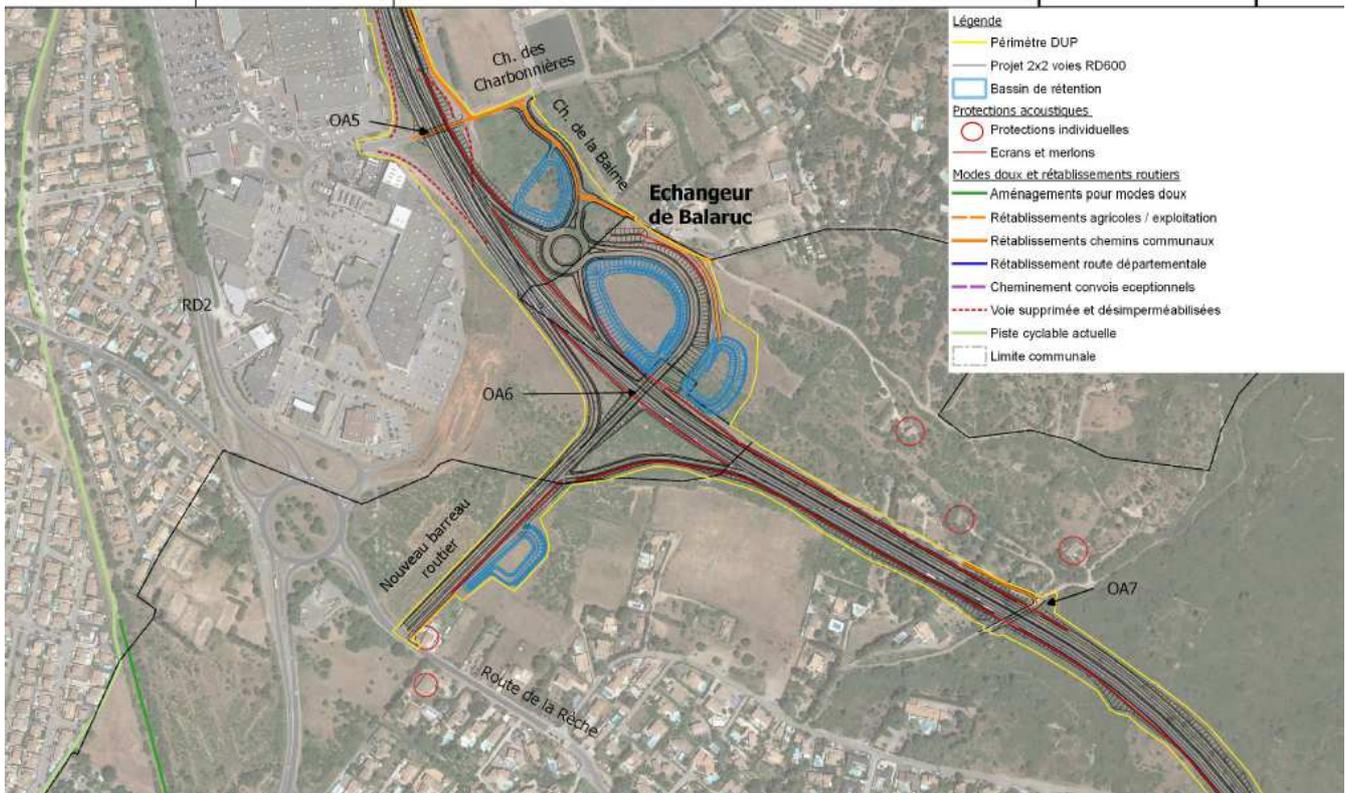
travaux prévus au droit de la zone commerciale de Balaruc-le-Vieux (extrait du plan général des travaux : volume A – pièce 4)
